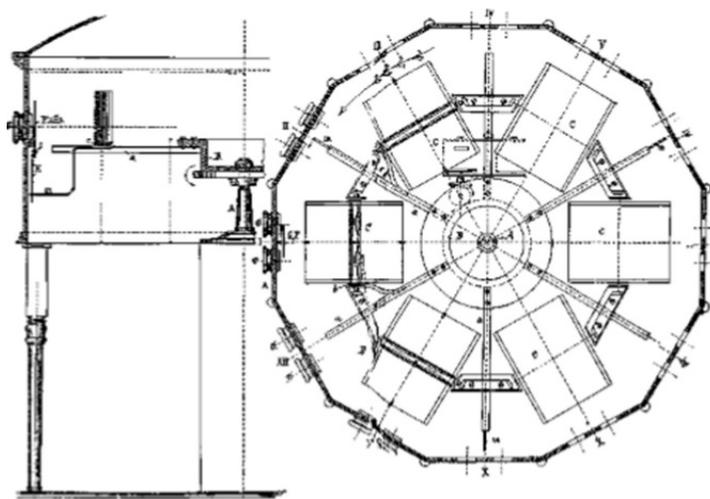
Plano e seção transversal, Kaiserpanorama. Unbinding Vision, 1879
